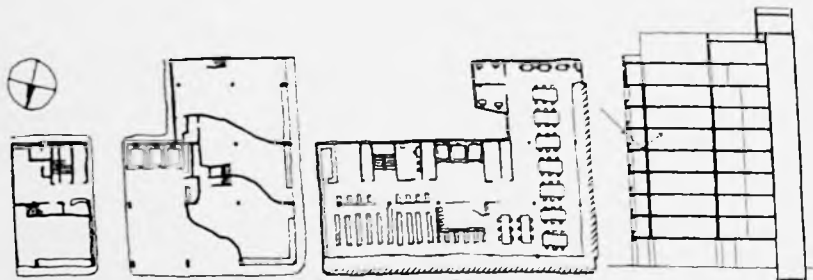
Planta térreo, pavimento tipo e corte generico da ABI.
